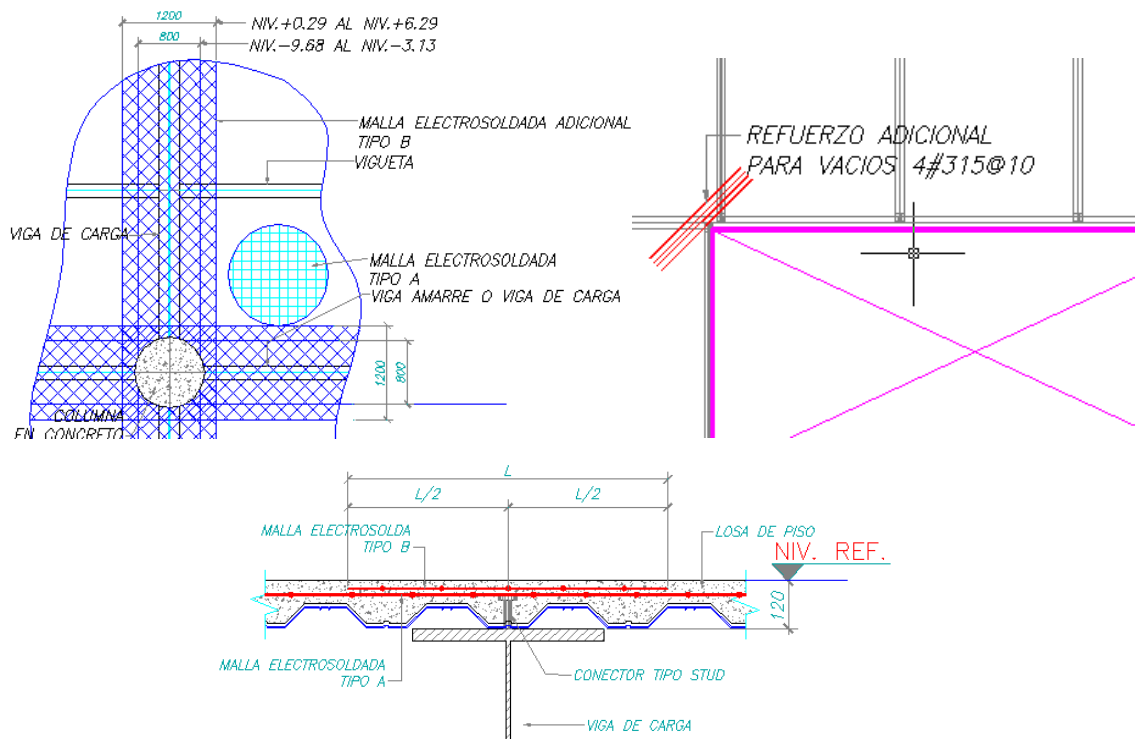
Detalles de acero en losas de entrepiso. Fuente Estrumetal
